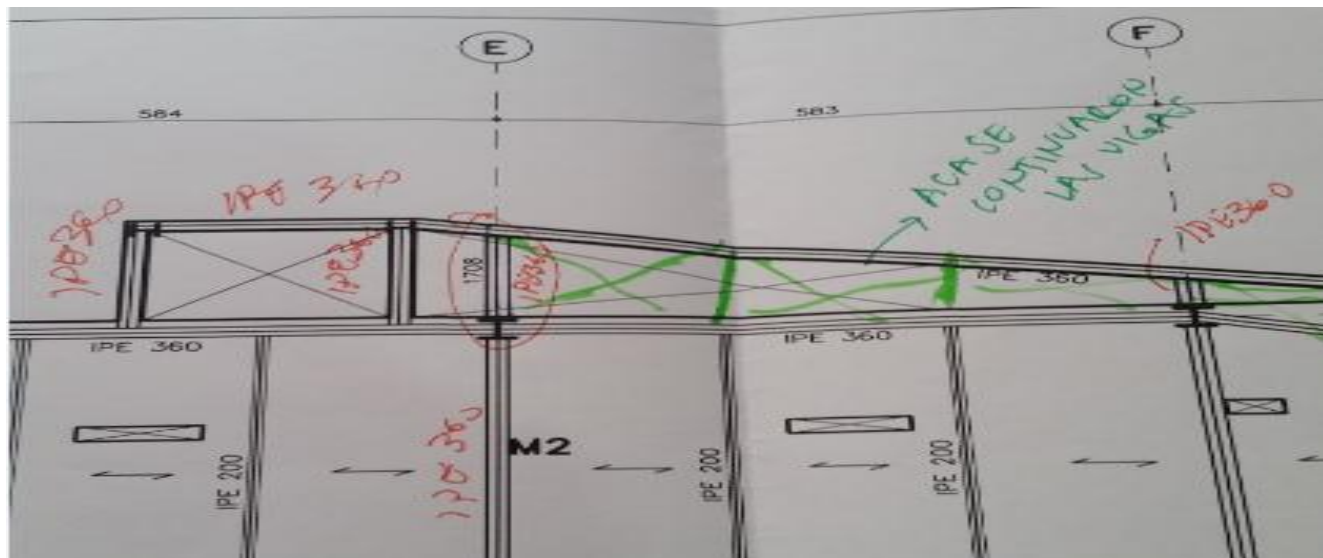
PLANTEAMIENTO ESTRUCTURAL.
